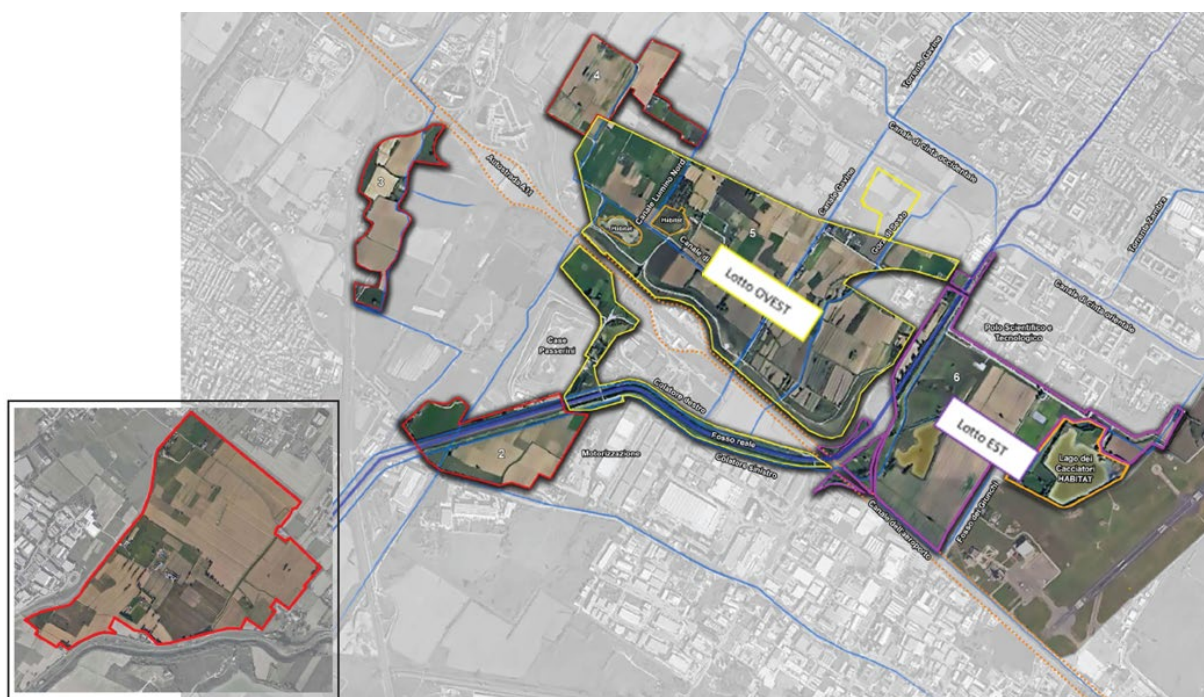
Planimetria di cantierizzazione: suddivisione in macro lotti
